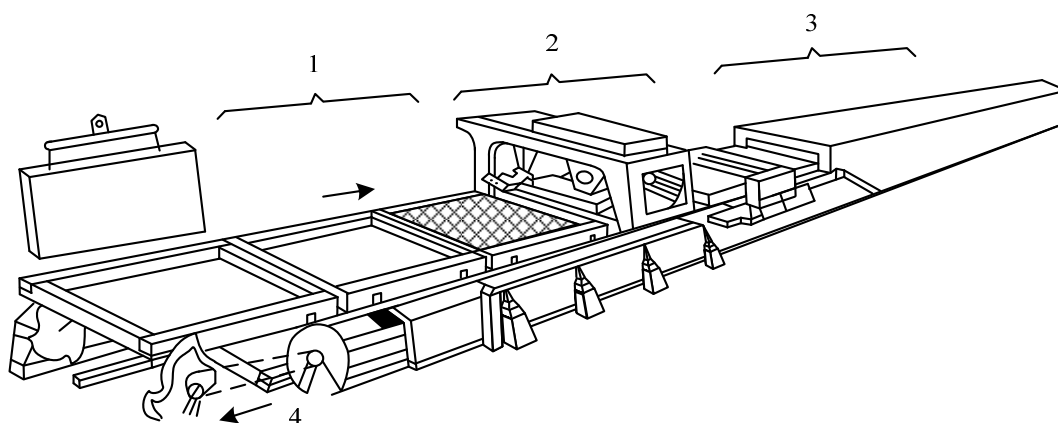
Двухъярусный стан для изготовления сборных железобетонных изделий: 1 – пост подготовки форм и установки арматуры; 2 – пост формования; 3 – камера предварительной тепловой обработки; 4 – щелевая камера (нижний ярус) окончательной тепловой обработки
